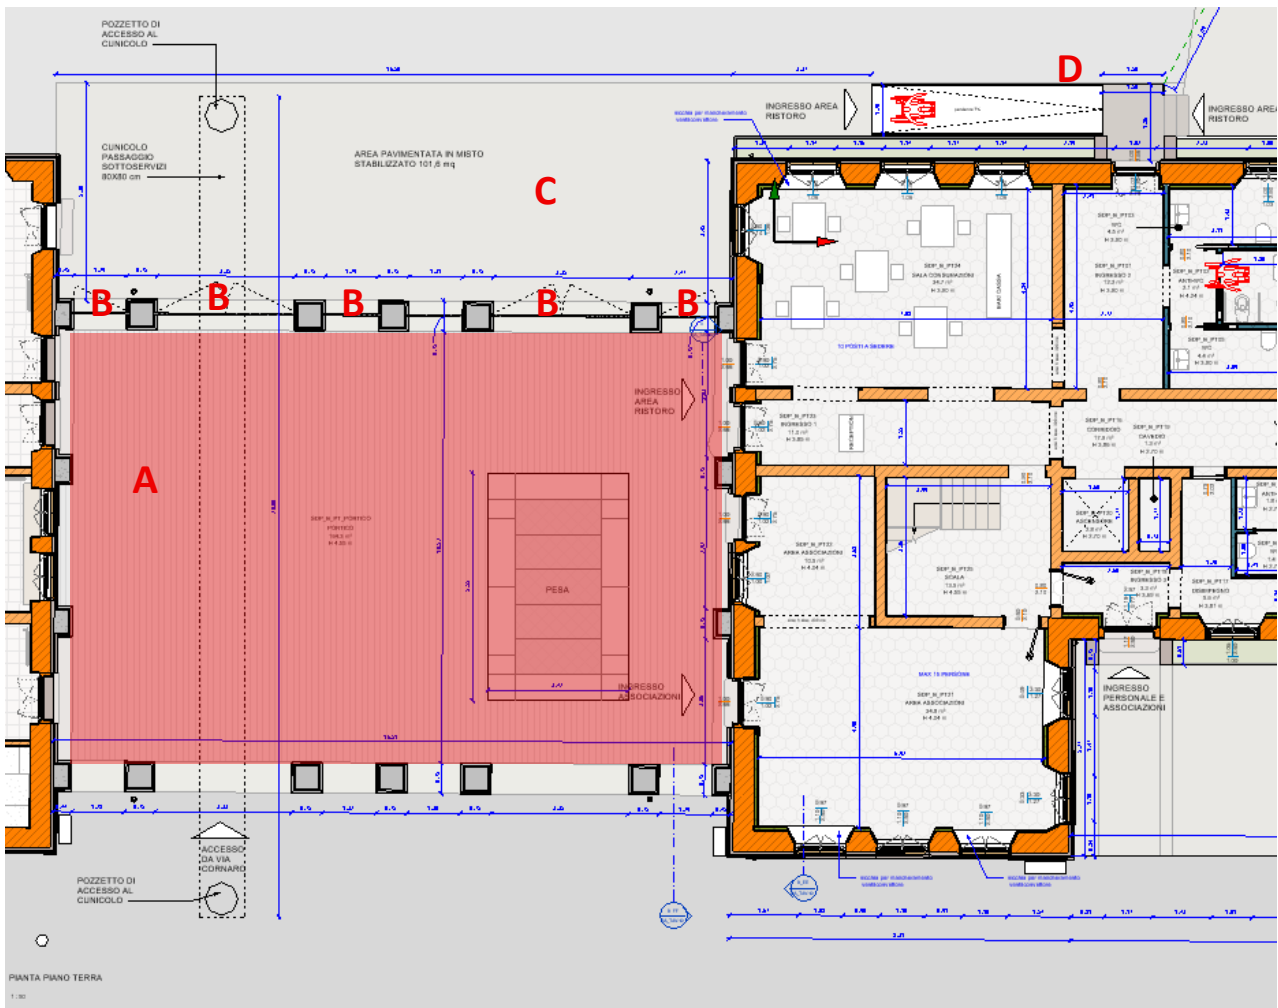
EDIFICIO B - Stato di progetto pianta area portico.
